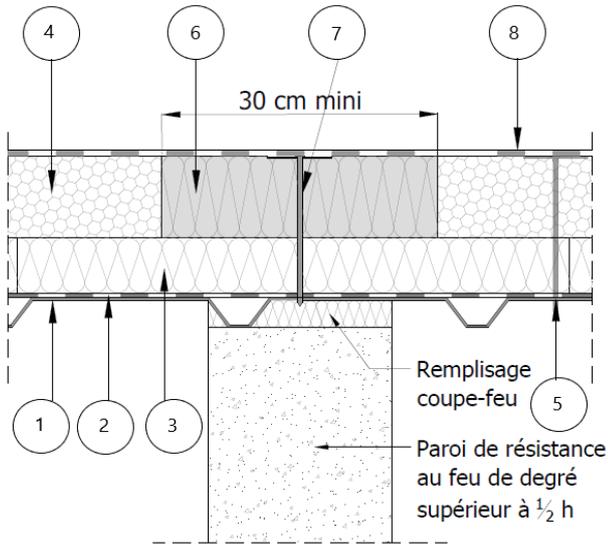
Exemple de recouplement au droit d'une paroi verticale
